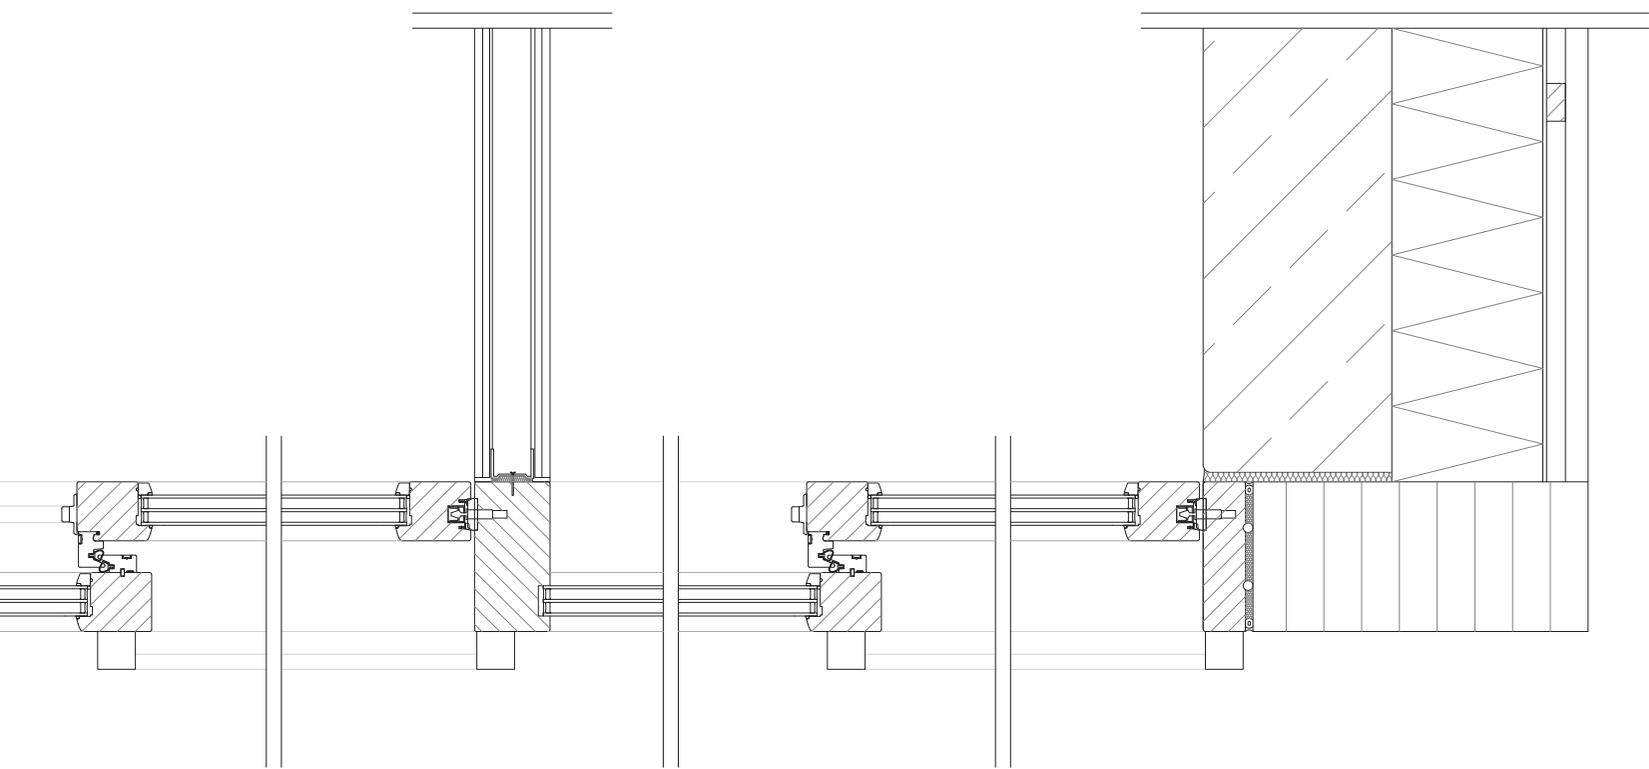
Horizontalschnitt Glasfassade OG M1:10
